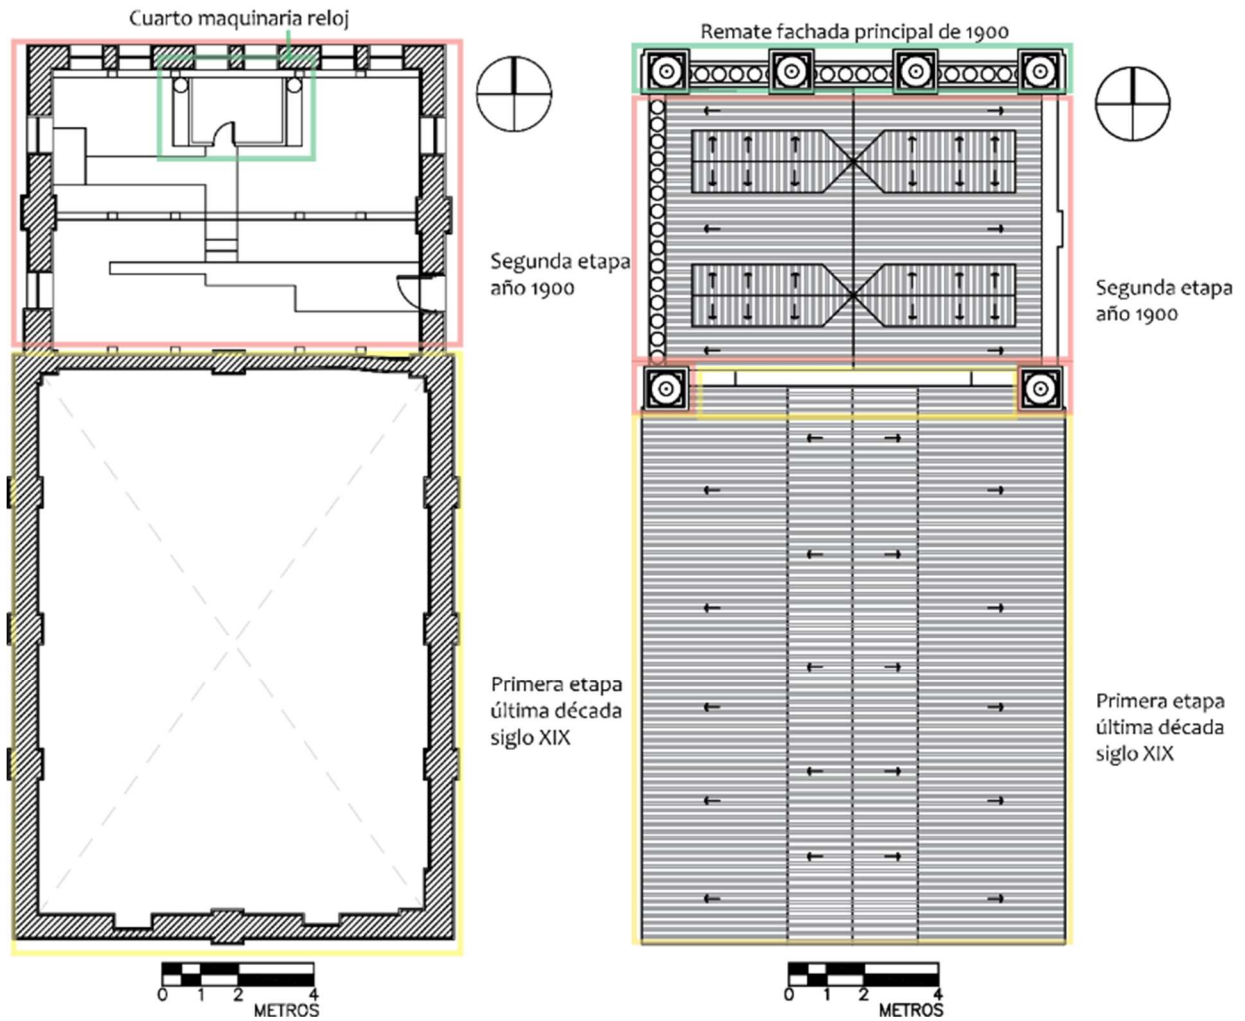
y 90. Levantamiento del estado actual. Planta mezzanine (derecha) y planta de azotea (izquierda), se puede apreciar su cubierta a dos aguas en ambas crujías y la crujía norte cuenta con buhardillas para iluminación y ventilación.
